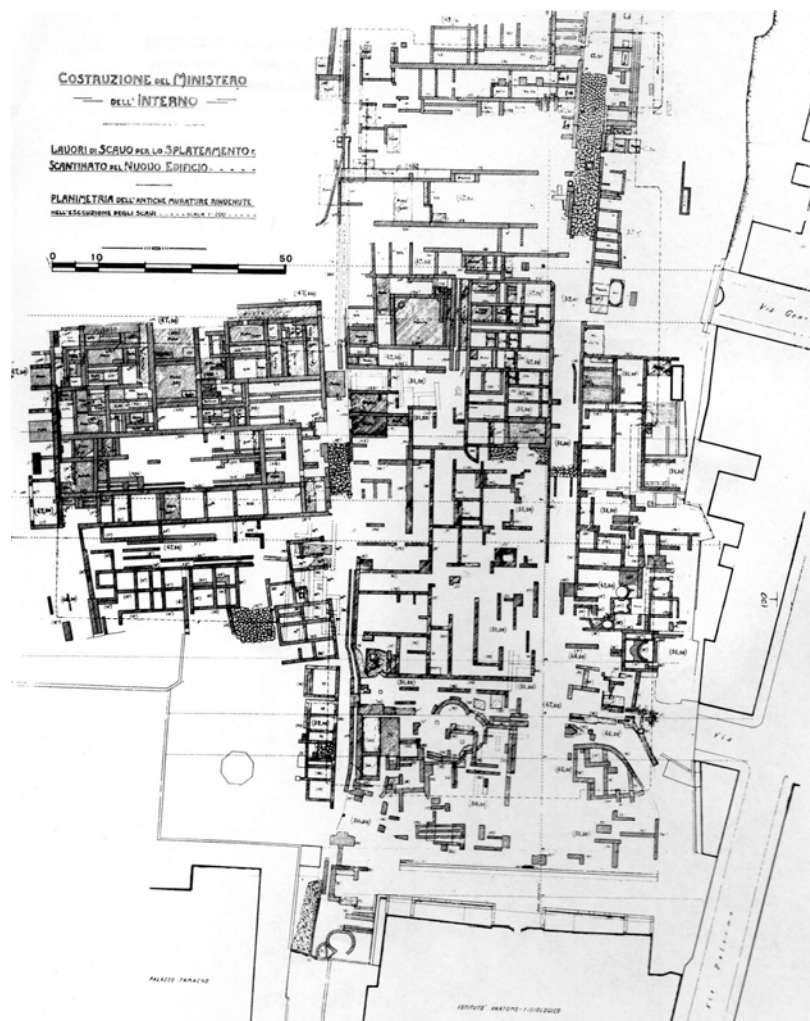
Planimetria delle antiche strutture murarie rinvenute durante gli scavi per la costruzione della sede del Ministero dell'Interno (da DE CAPRARIIS 1987-1988)
